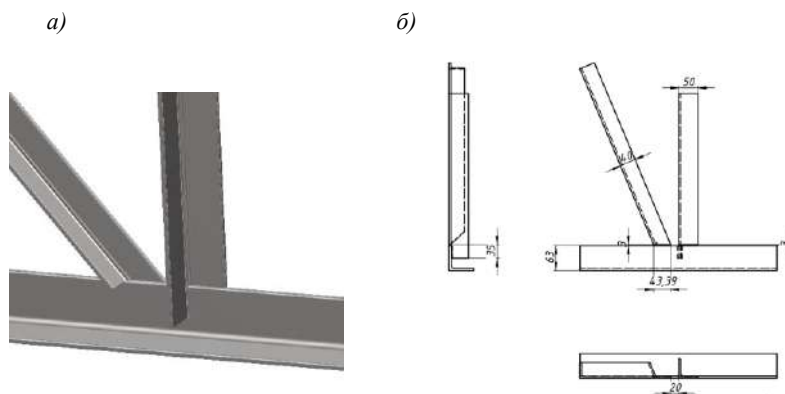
Сварной узел нижнего пояса:
